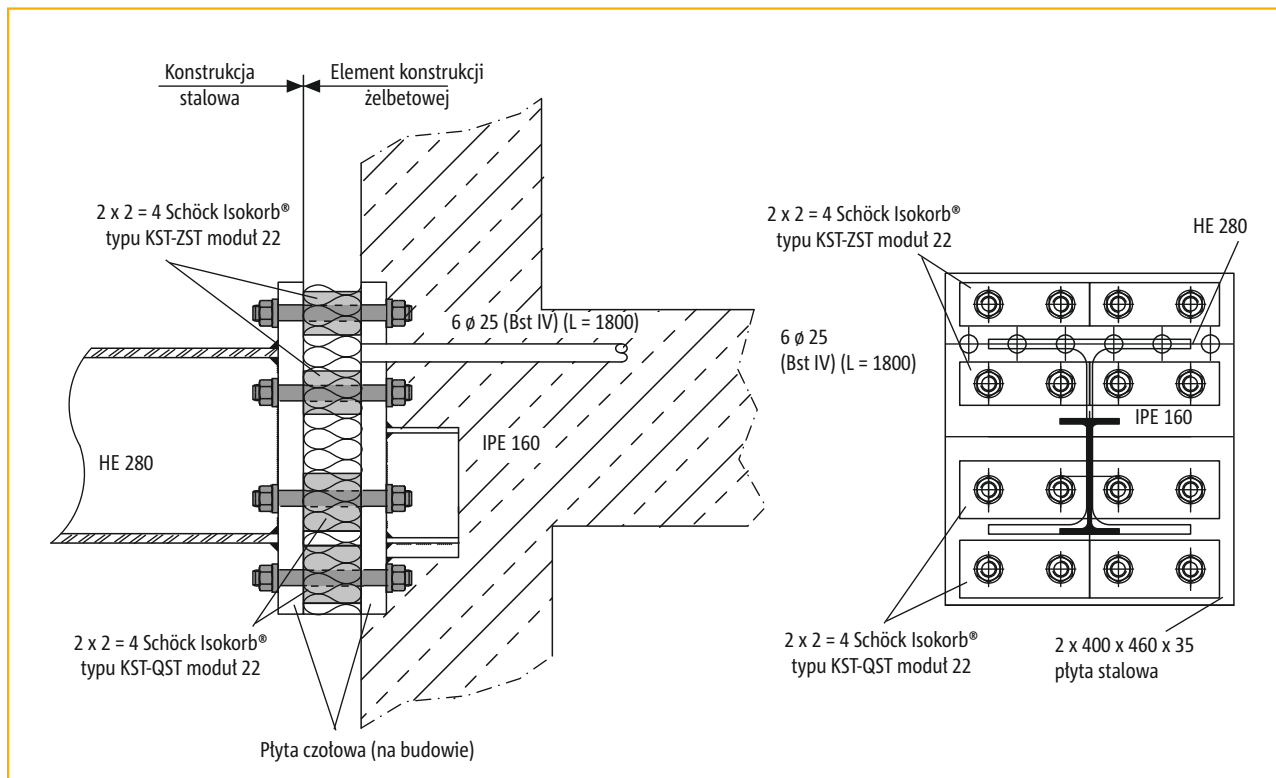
Schöck Isokorb® typu KST-ZST dla konstrukcji stalowych podpartych na słupach
